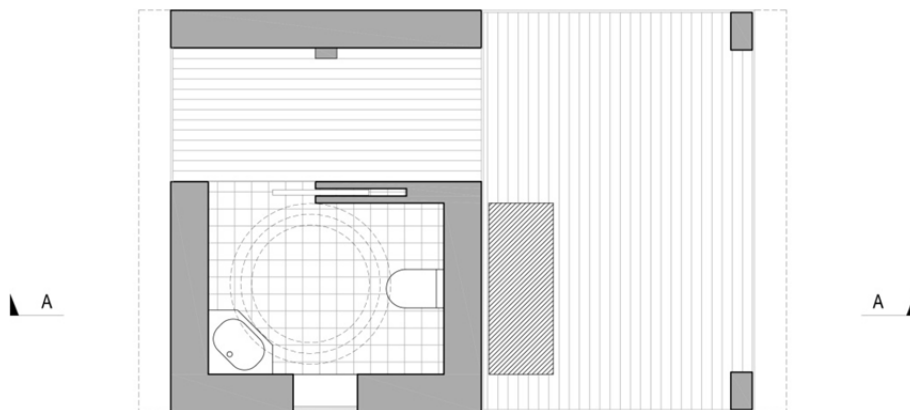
Planta do módulo de abrigo. *Proposta de intervenção.
